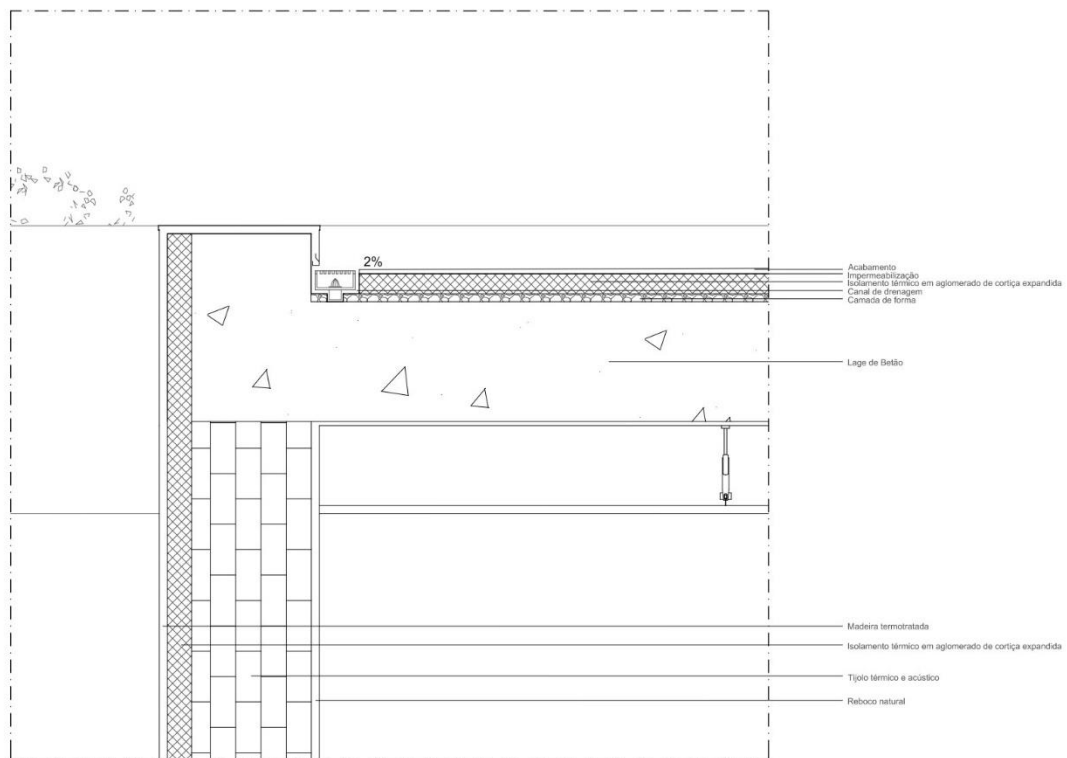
, PORMENOR CONSTRUTIVO DA COBERTURA PLANA
